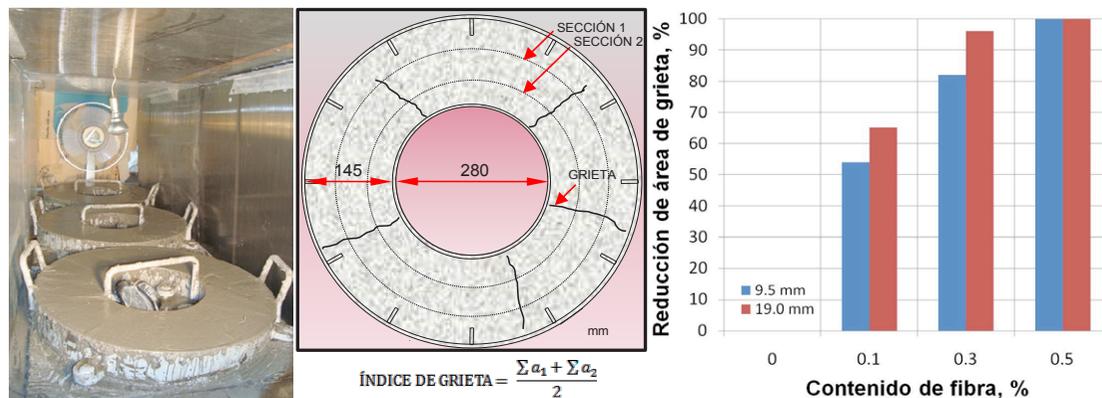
Ensayo de agrietamiento por contracción plástica - ACI544.2R.
